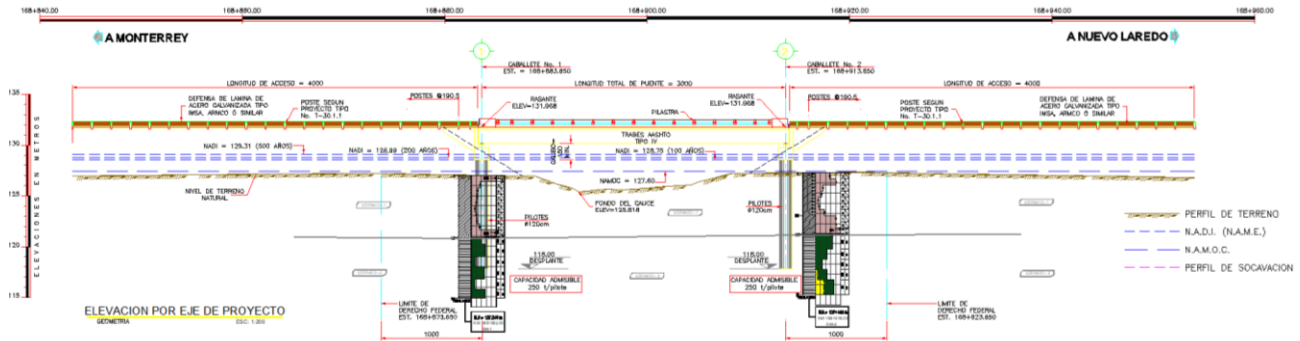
Plano de elevación del puente, se puede observar las pilas-pilotes que serán el soporte de la estructura.
